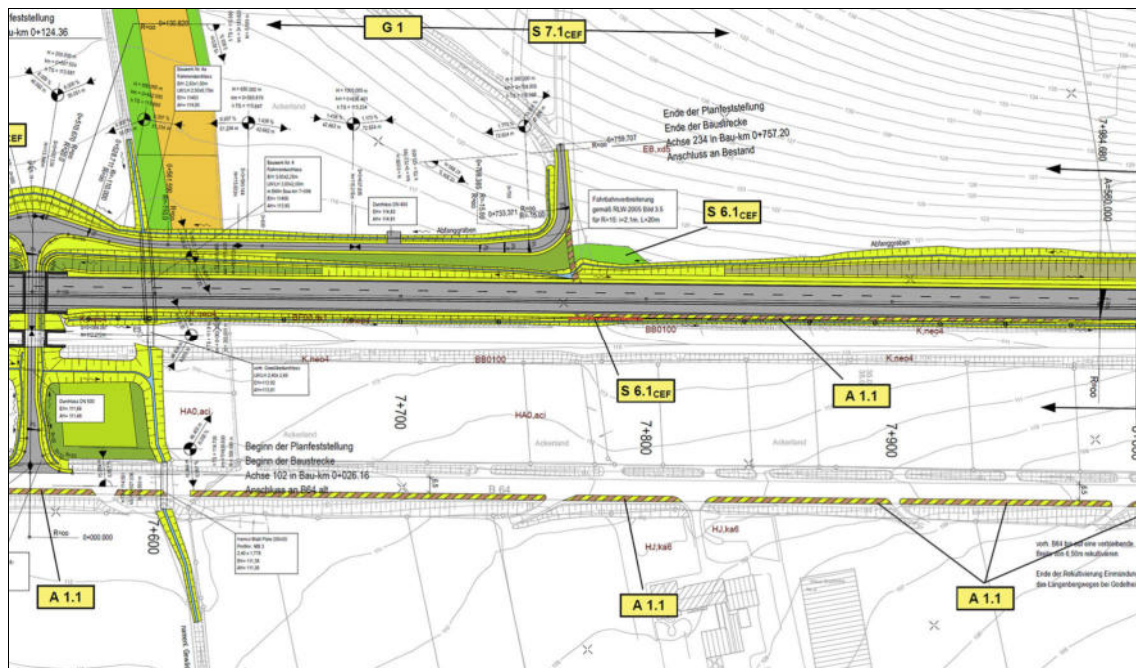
Ausschnitt aus dem Maßnahmenlageplan des LBP zu F 1.
